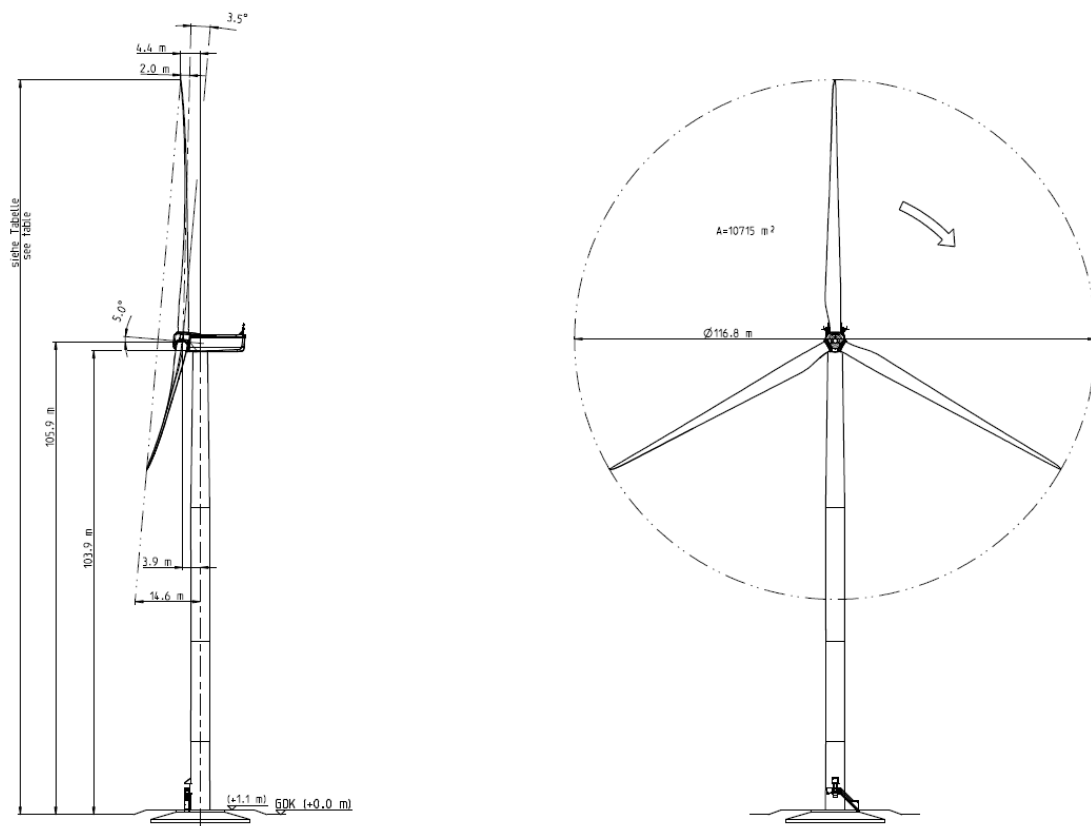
Plans en coupe de l'éolienne N117 - 3.6MW (hauteur de moyeu de 106 m)
